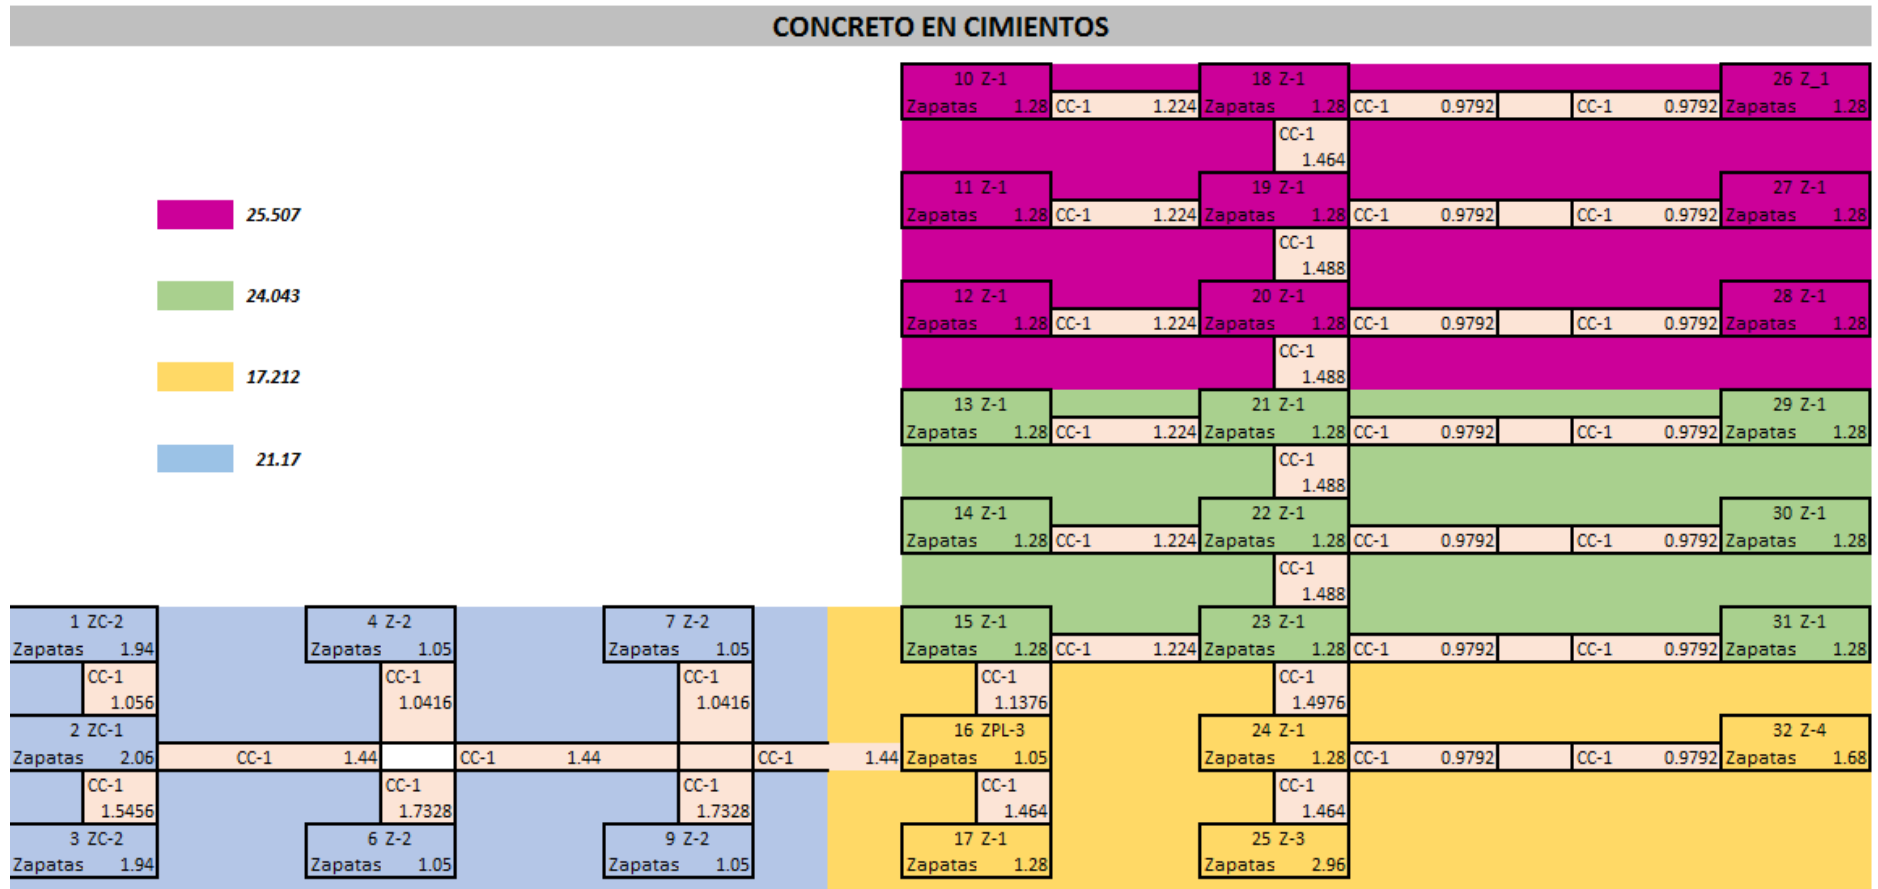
Detalle de Sectorización de Concreto en Cimientos (m³).
